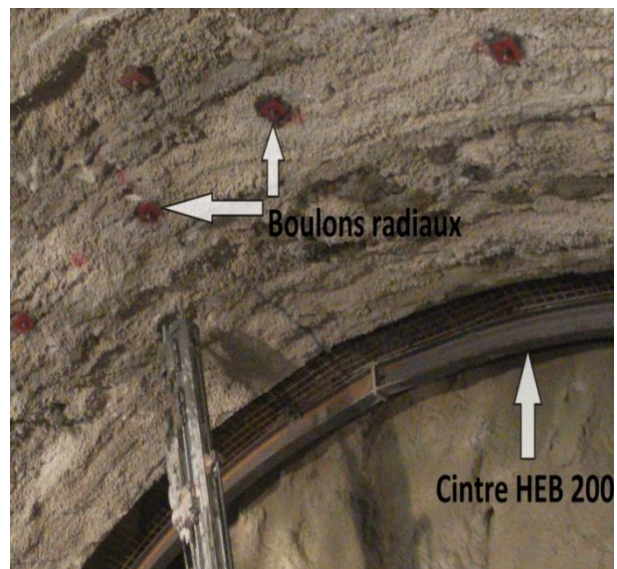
soutènement provisoire de la demi-section supérieure (Tunnel T4 –Algérie-)
